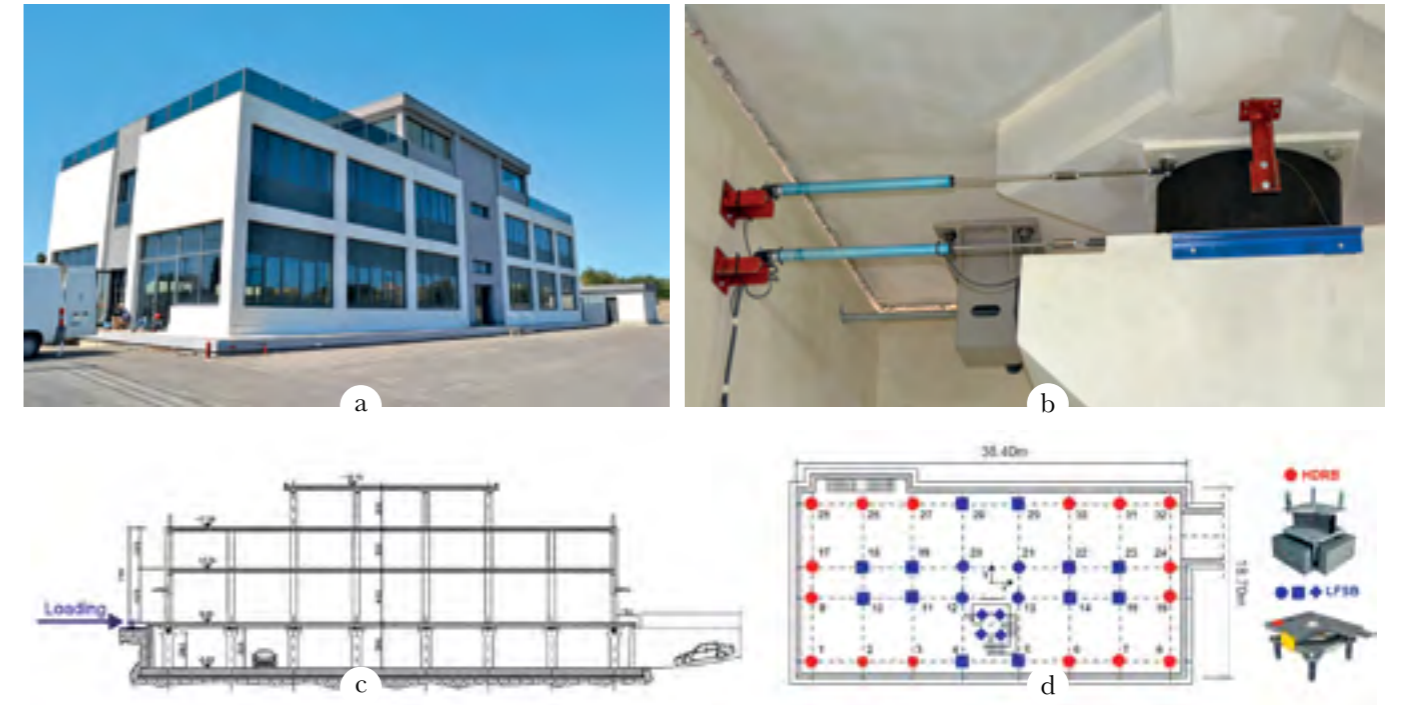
a) edificio testato ad Augusta; b) sistema di monitoraggio degli spostamenti; c) prospetto e d) pianta edificio isolato alla base.
